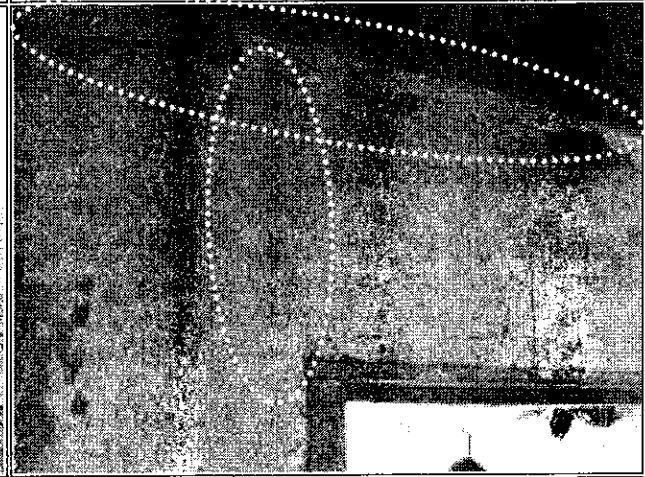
Fisuras longitudinales y transversales que afectan un muro interno de la vivienda en estudio..
